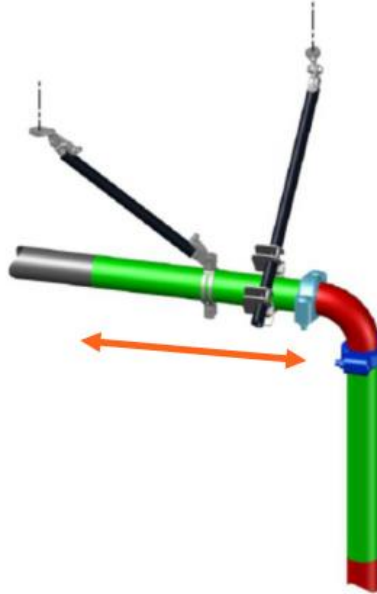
Soporte sísmico de 4 vías colocado en la tubería horizontal de la tubería vertical
